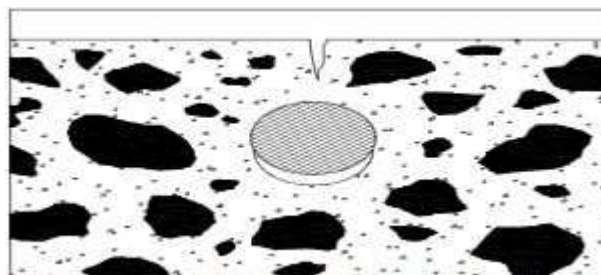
Fisura formada debido a una precipitación obstruida
